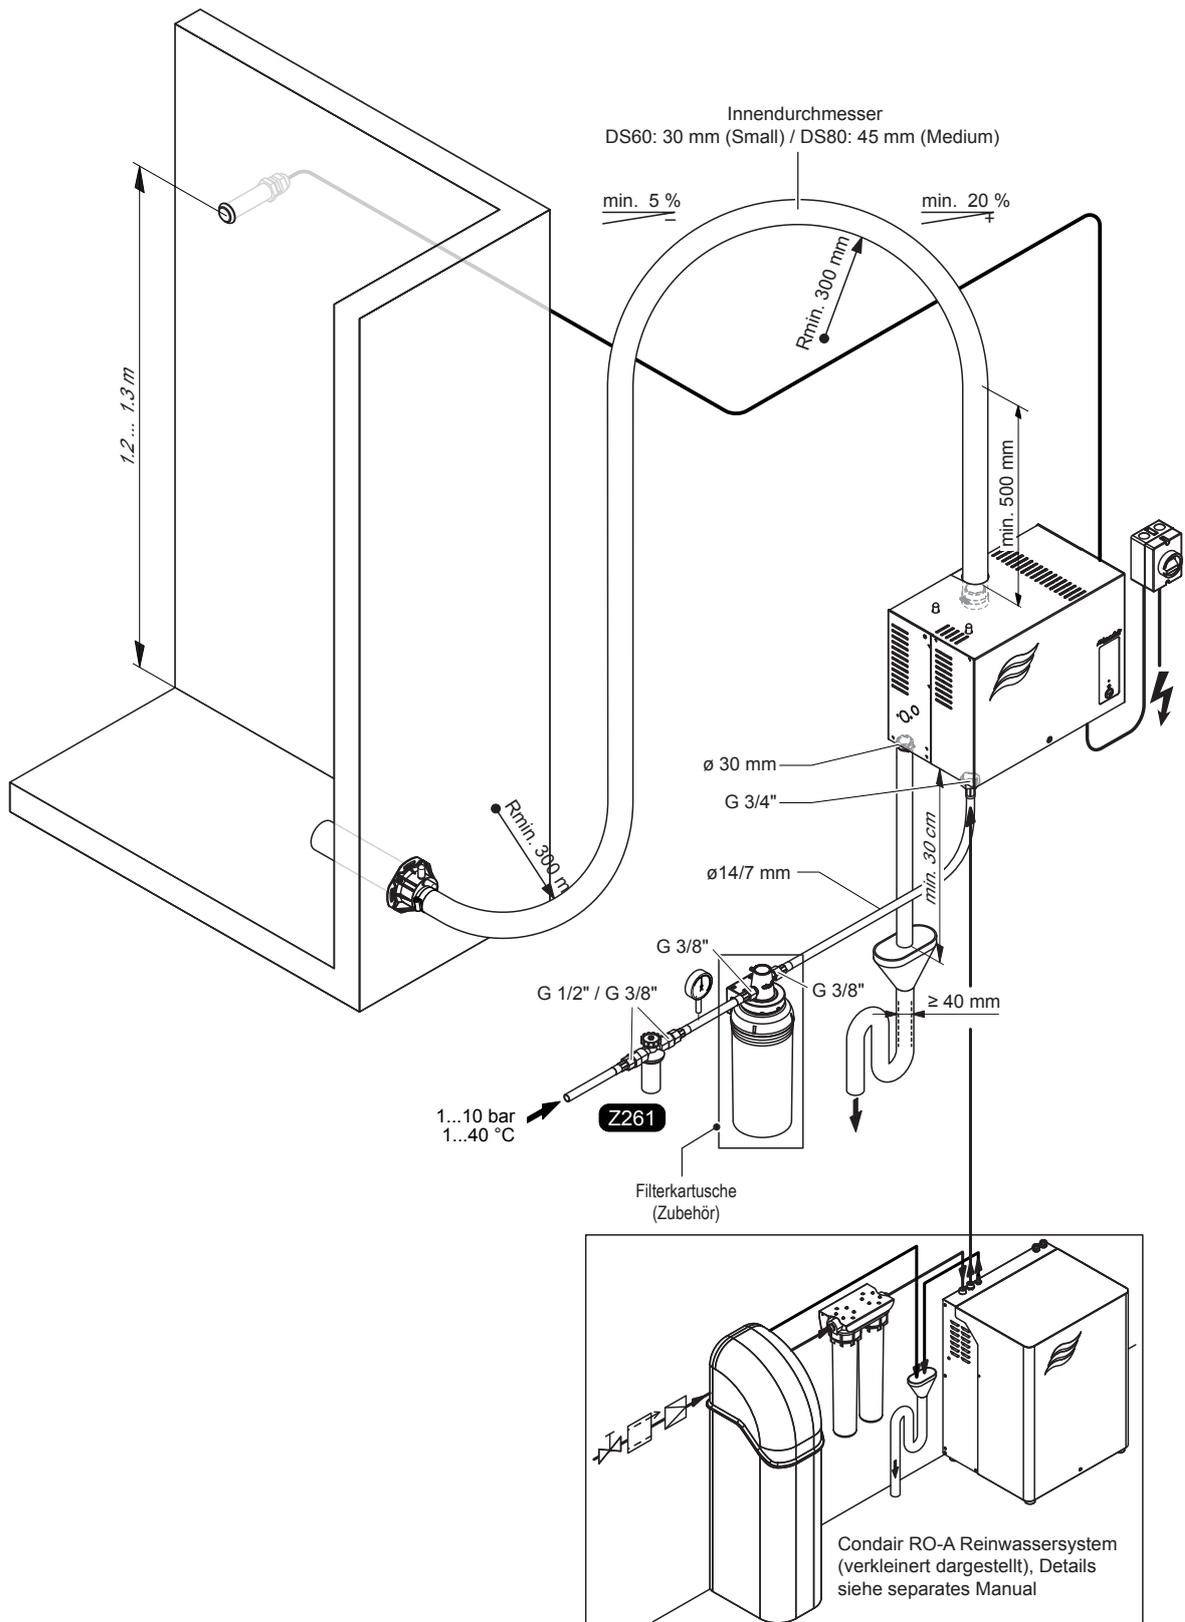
Installationsübersicht (Ausführung mit Wasserzu- und ablaufanschluss auf der Geräteunterseite)
